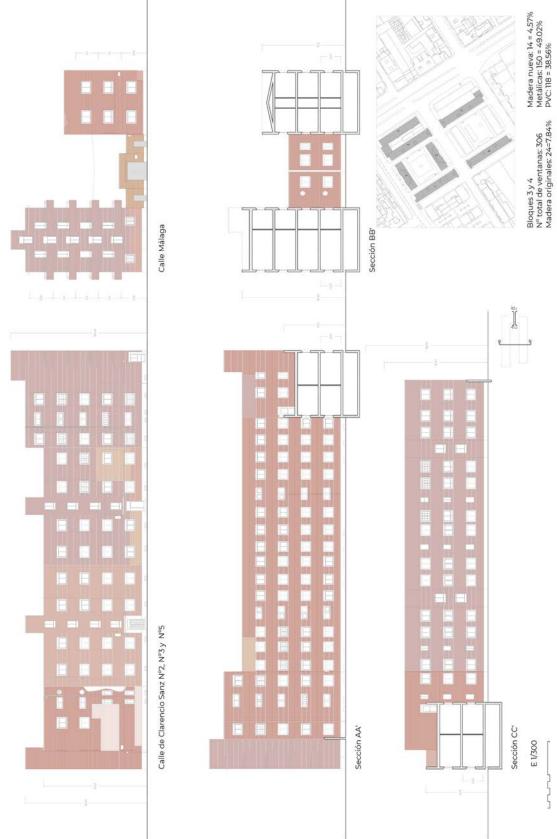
c.21. Planimetría del BLOQUES 3 y 4. Obra del Hogar Nacional Sindicalista
